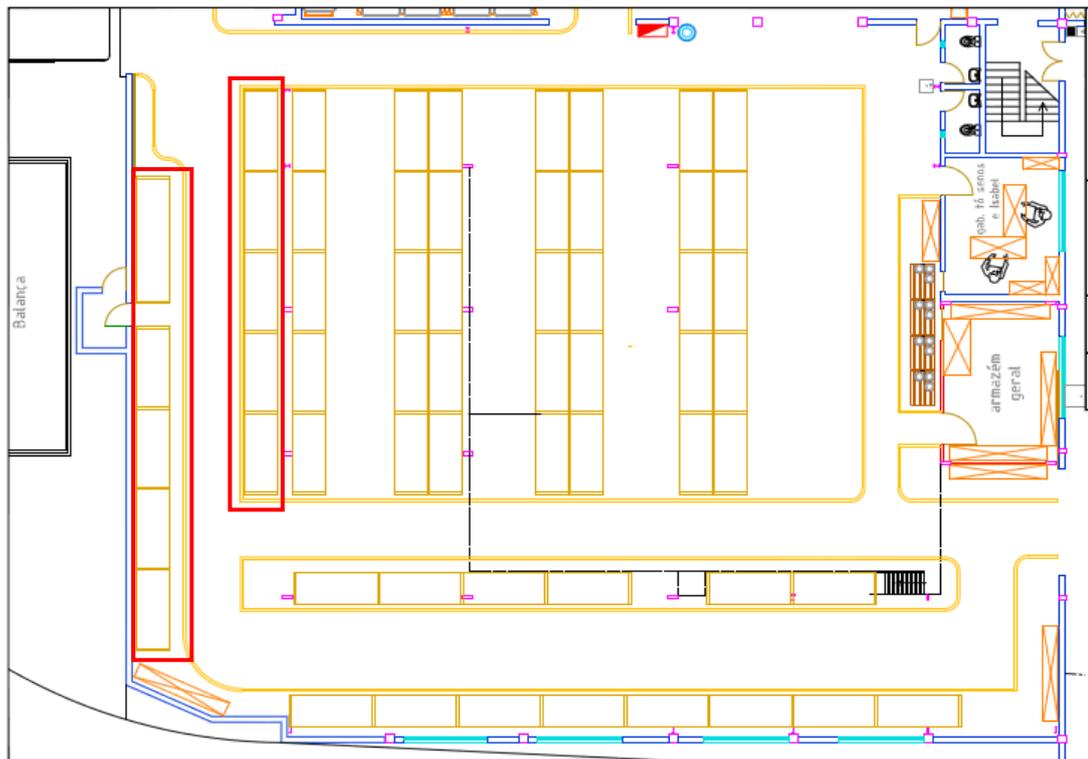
Layout* da alternativa I do armazém de embalagens
